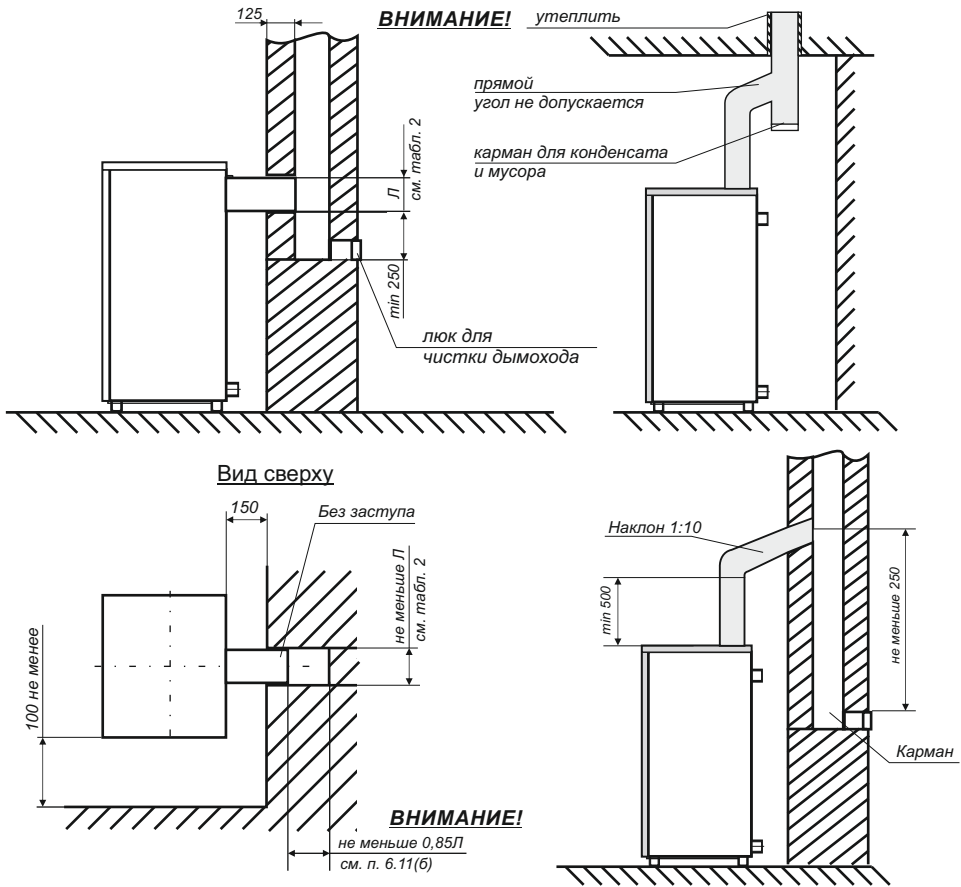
Схема подключения котла к дымовому каналу и план установки котла
